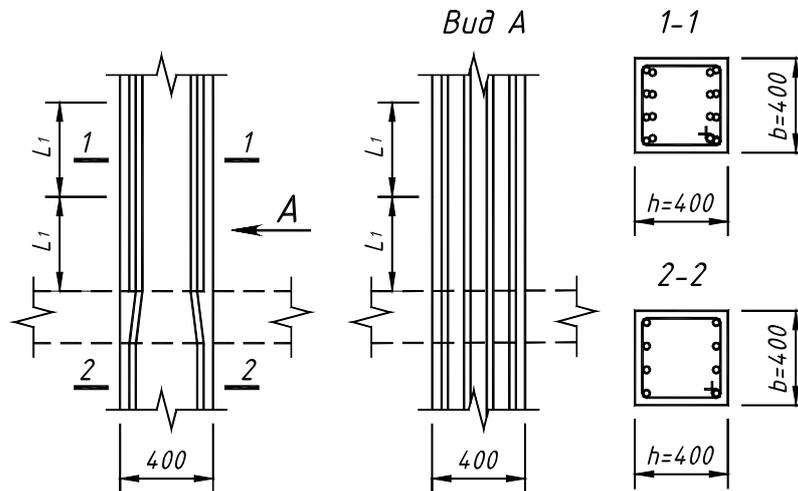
Пример устройства стыков арматурных стержней внахлестку без сварки
